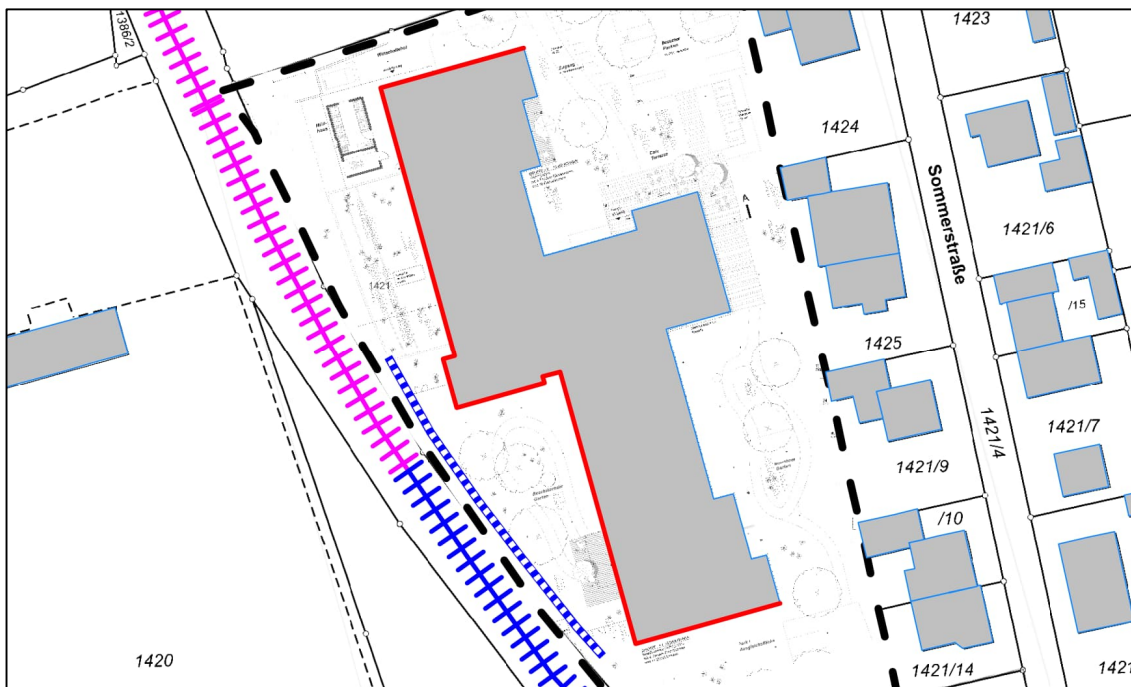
Lageplan mit Kennzeichnung der Fassaden, an denen passive Schallschutzmaßnahmen auf Höhe des 2. Obergeschosses notwendig sind
